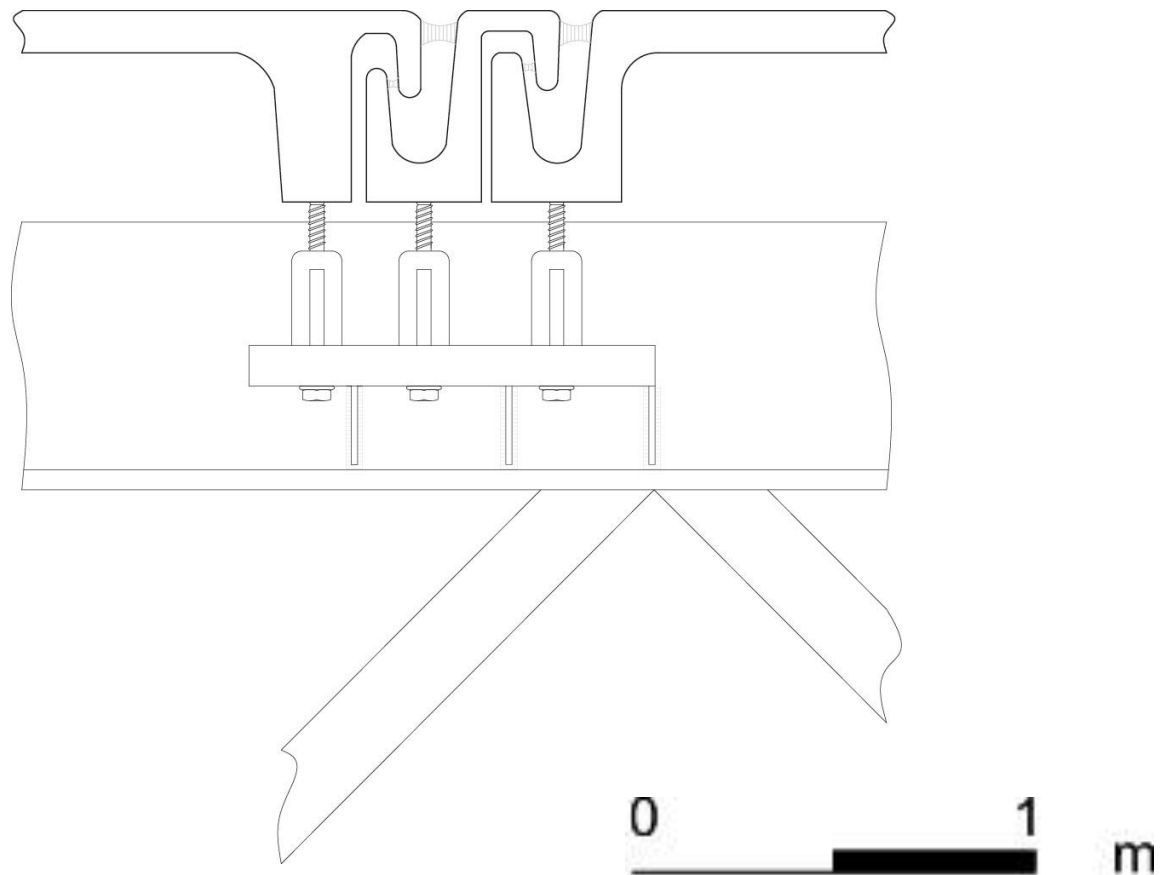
Detalle de la unión y anclaje de los paneles de la cubierta. Escala 1/50.
